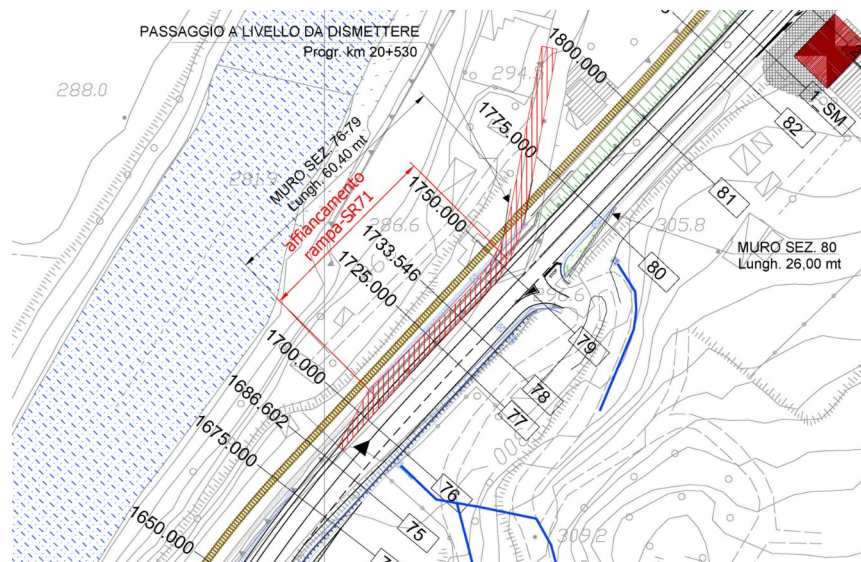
Nuova immissione in progetto sovrapposta alla planimetria variante SRT 71
